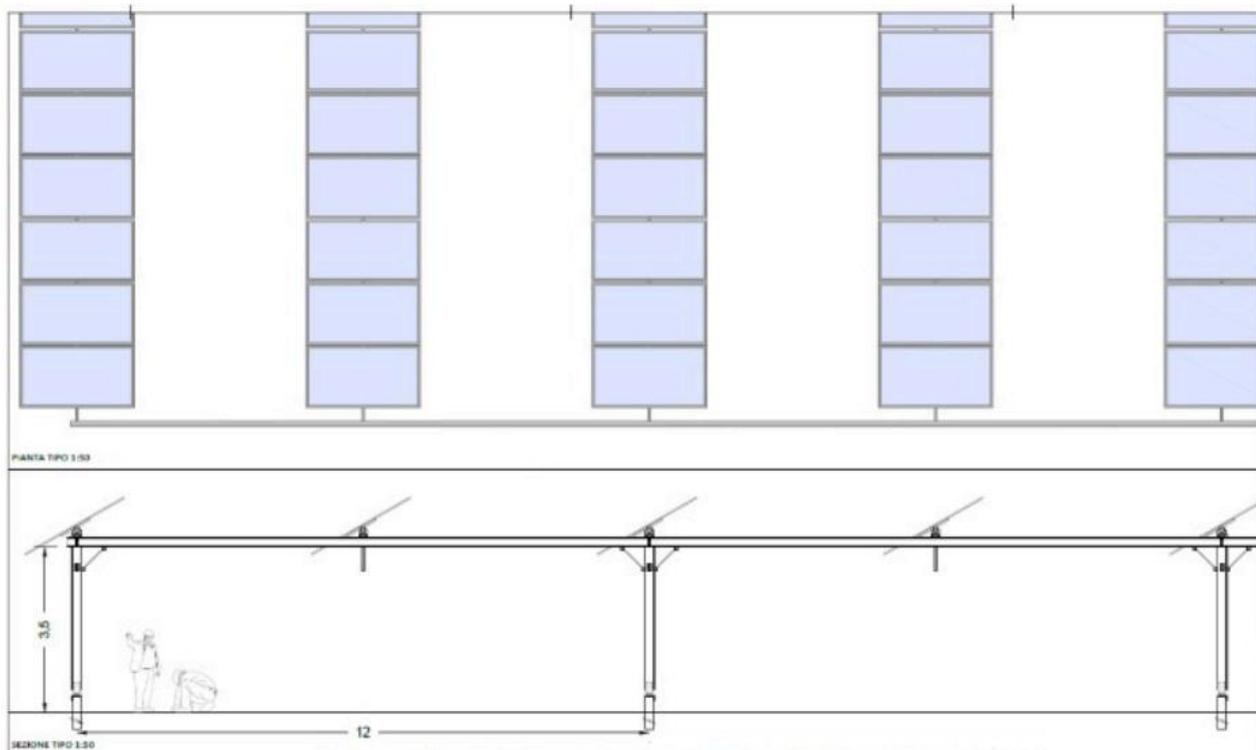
PARTICOLARE IN PIANTA E PROSPETTO TRACKER
